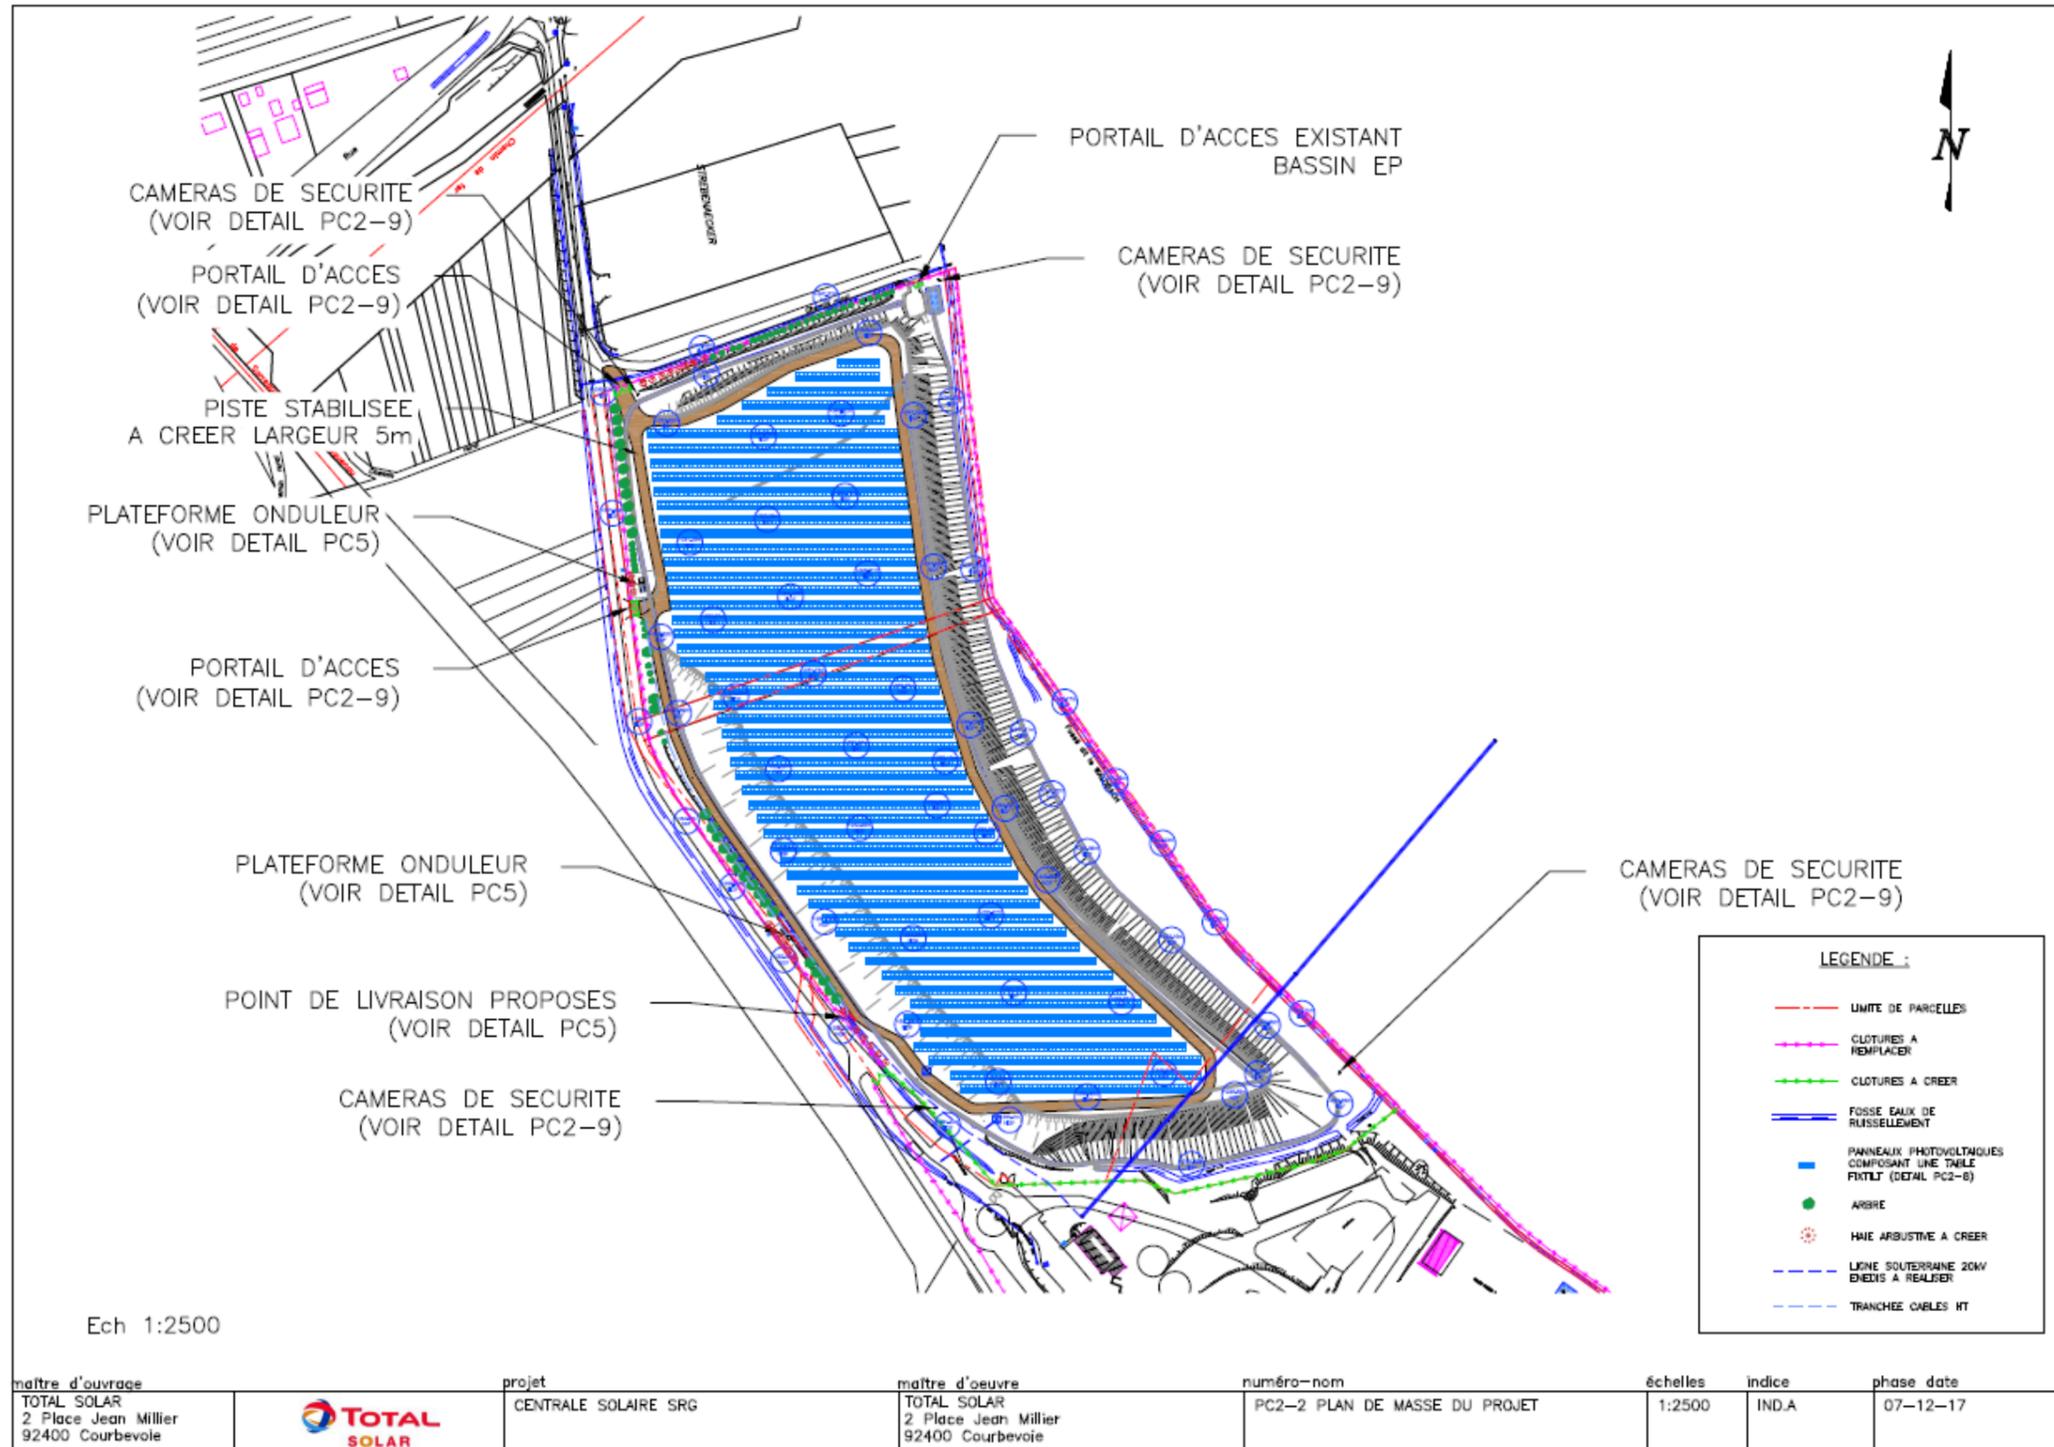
Plan de masse de la centrale (version du 7/12/2017)
